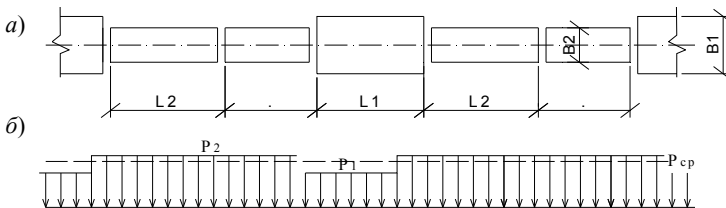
Конструкция из одной широкой плиты с двумя узкими разной длины (а); эпюра контактных напряжений от начала загрузки фундамента до обжатия верхнего слоя грунта (б)
